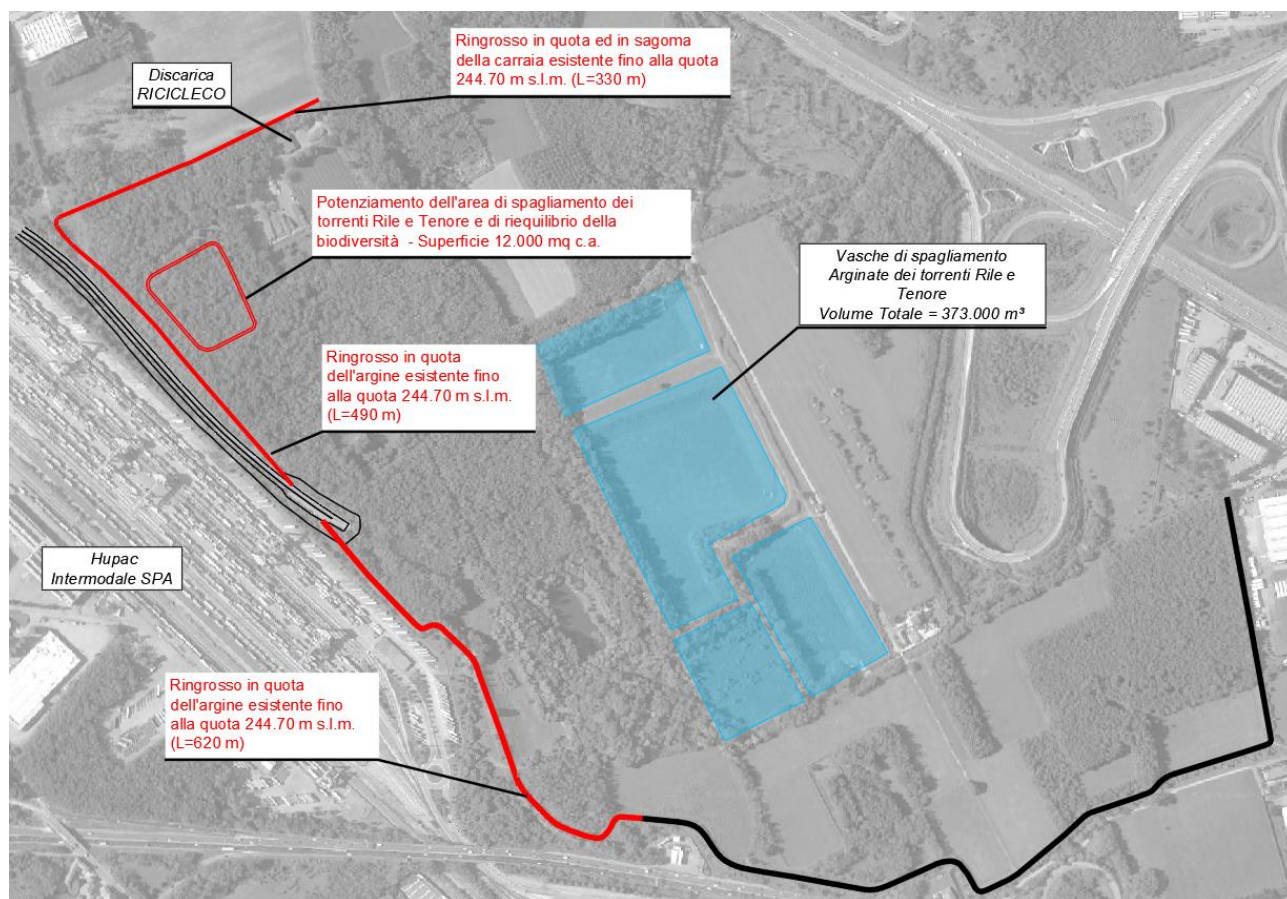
MASTERPLAN DELLE OPERE IN PROGETTO
